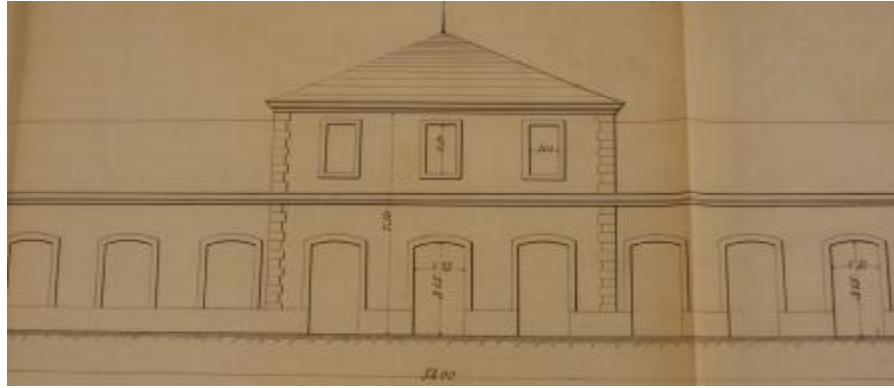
Alzado fachada principal. (I. Aguilar) (2011).
